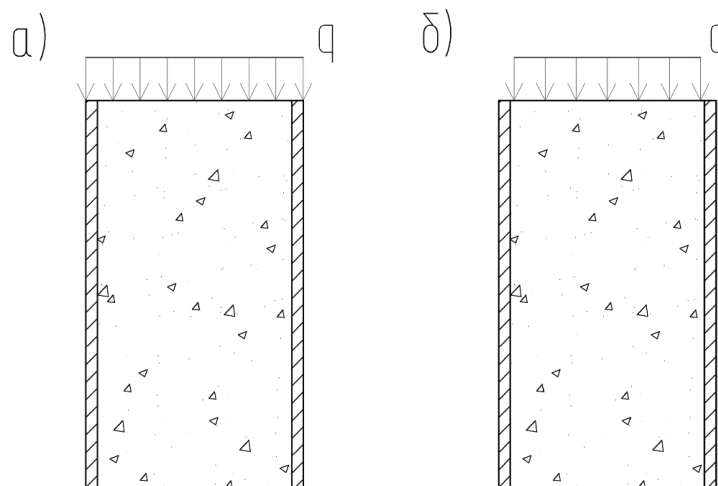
Схемы передачи усилия на ТБК: а) на все сечение; б) на бетон
